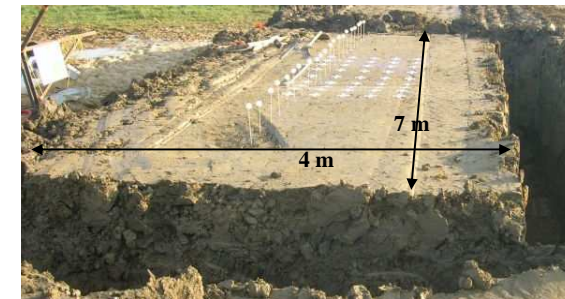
Plaque d'essai sur site d'après Camp (2008).
